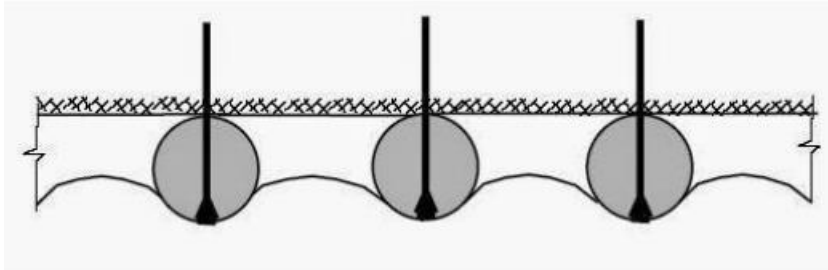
Execução de estaca hélice, final da concretagem e preparo para inserção da armadura
